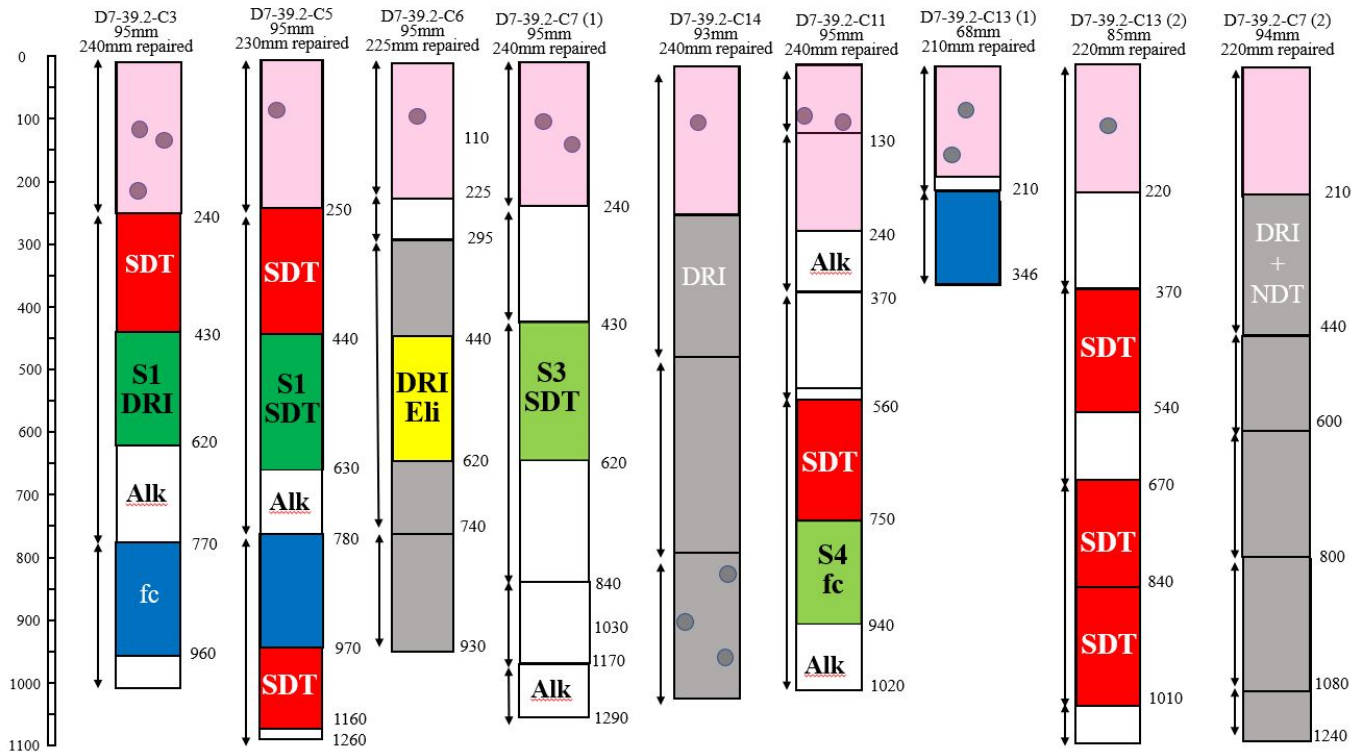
Plan d'essai D7-39-2 - Fournier et al, 2024
